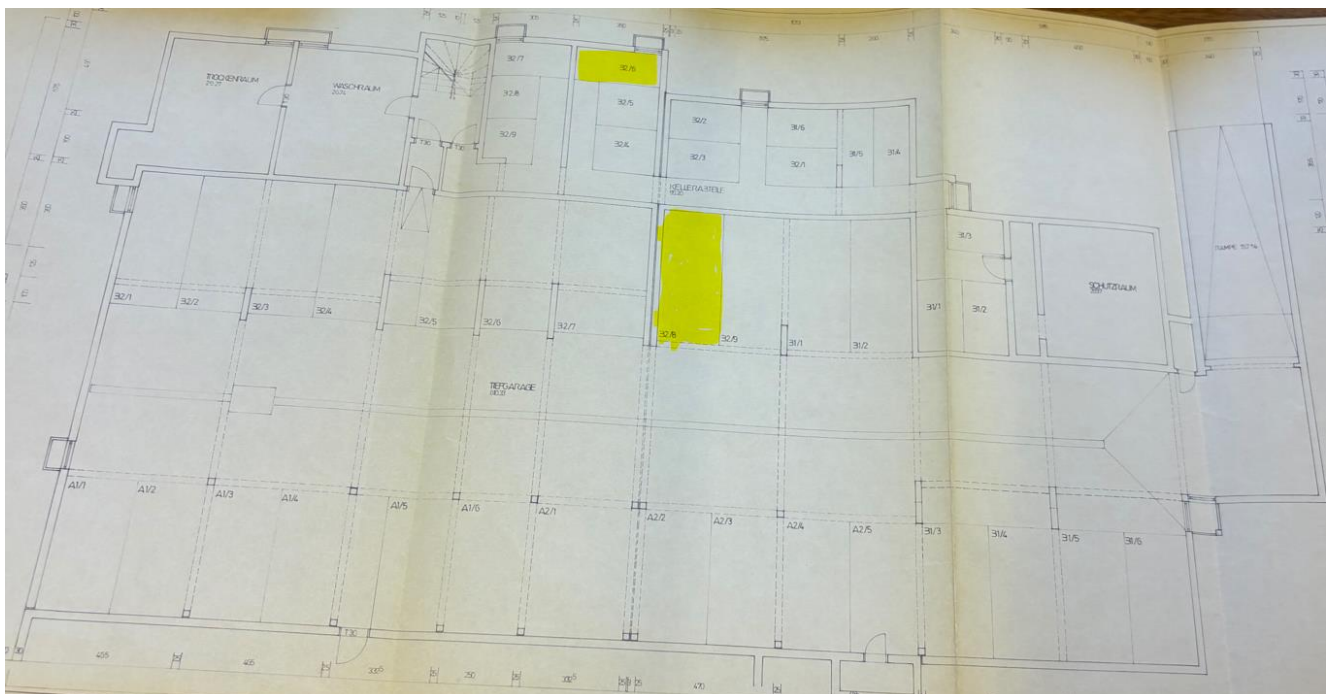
Grundriss TG Stellplatz und Kellerabteil gem. Einreichplan ZI 3165/85 v. 26.3.1986¹⁴
